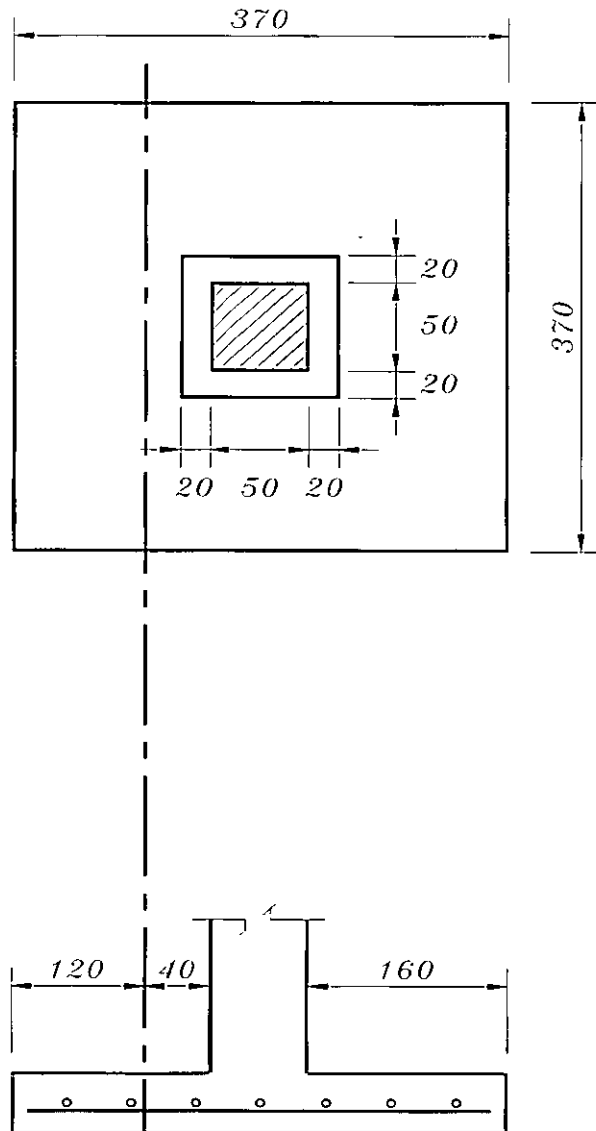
DISEÑO DE UNA ZAPATA AISLADA
